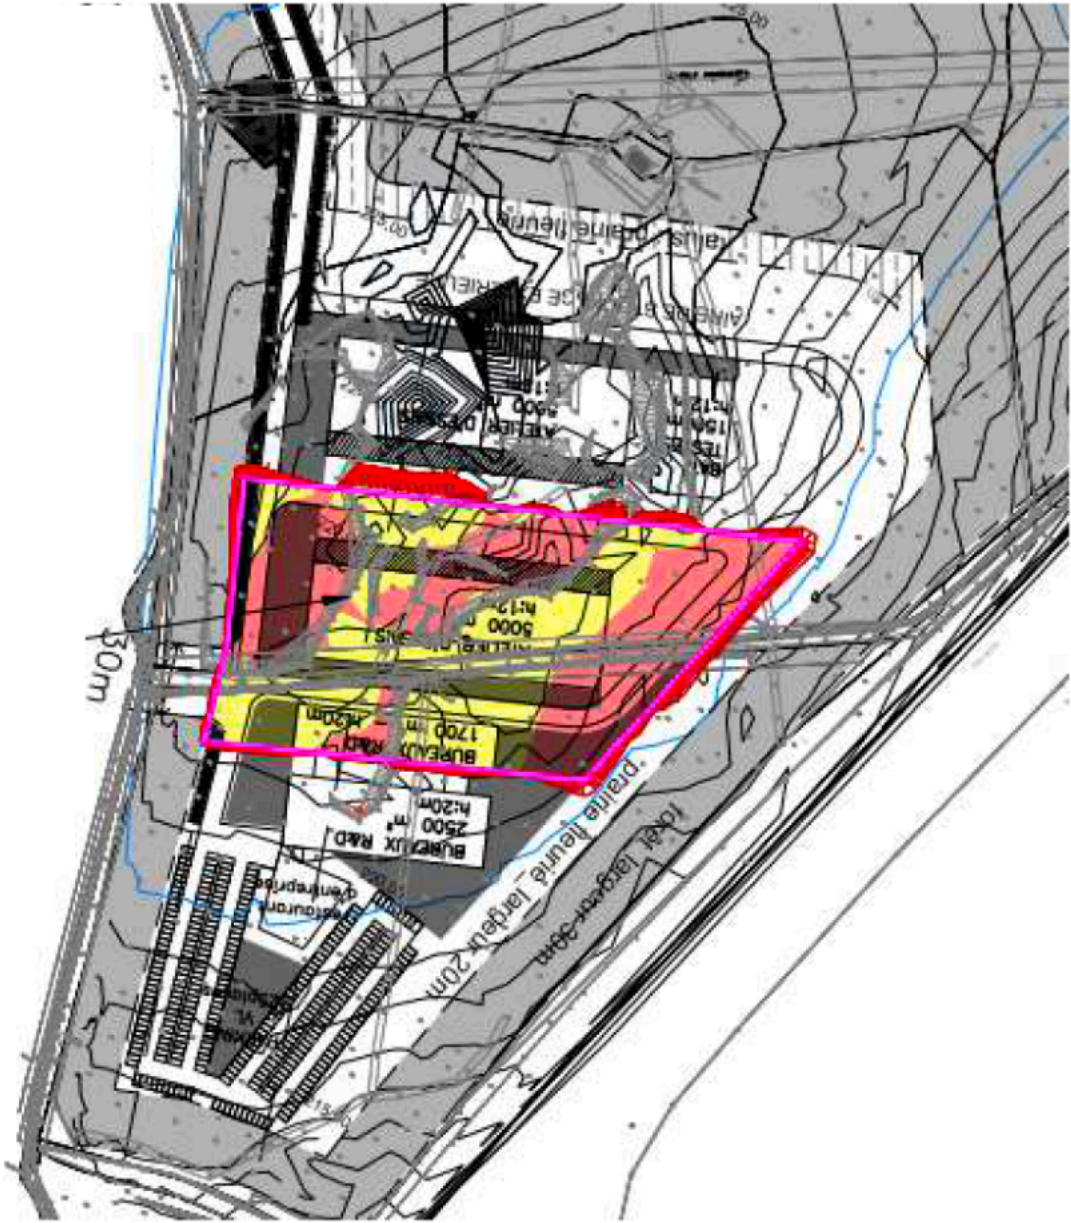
Extrait de plan de la modélisation de la plateforme 4 de l'extension Sud (source : mémoire technique OTE juin 2024)
